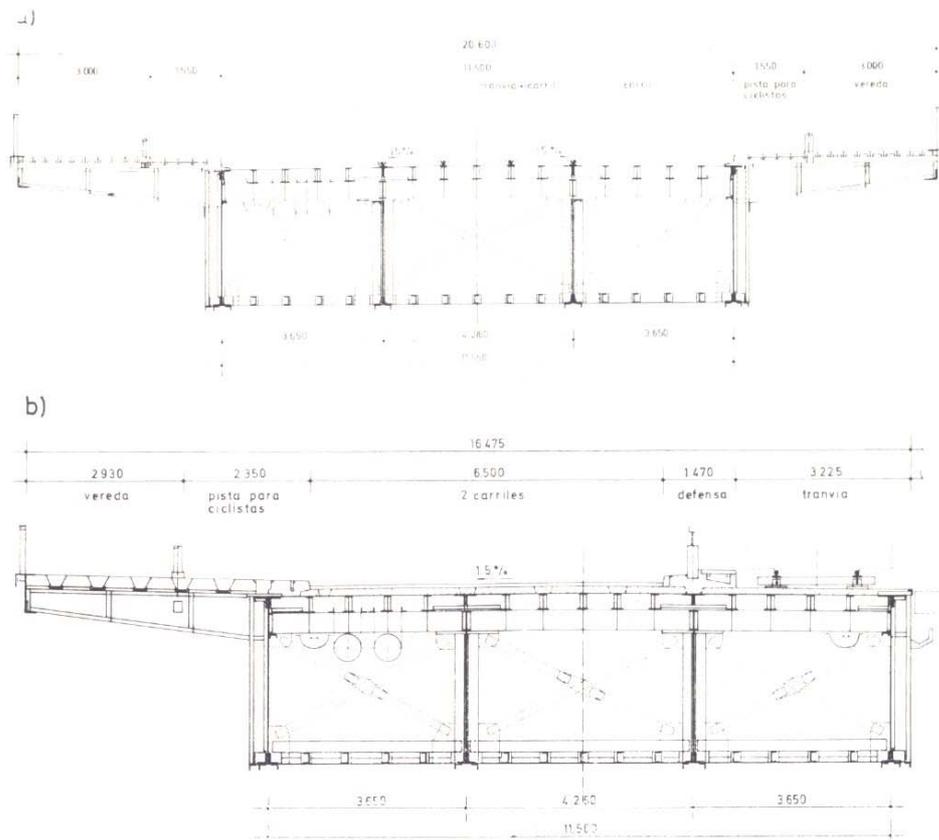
Puente Köln-Deutz - Remodelación del puente existente. a) Sección original. b) Sección nueva
